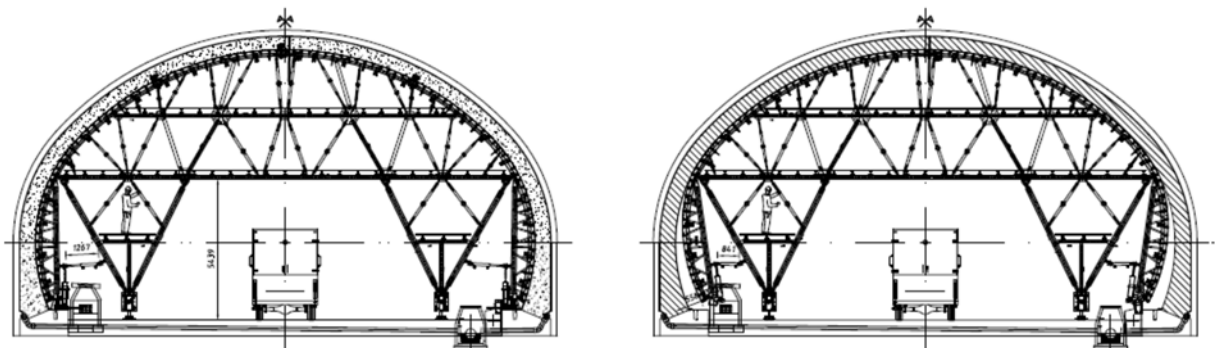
Carro de cofragem em posição de betonagem e em posição de descofragem (TAS)
